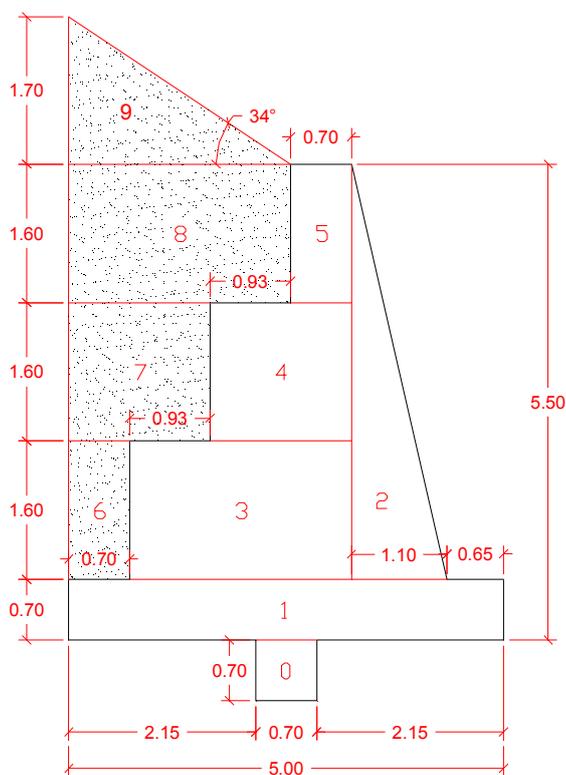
Seção transversal de muro de gravidade
